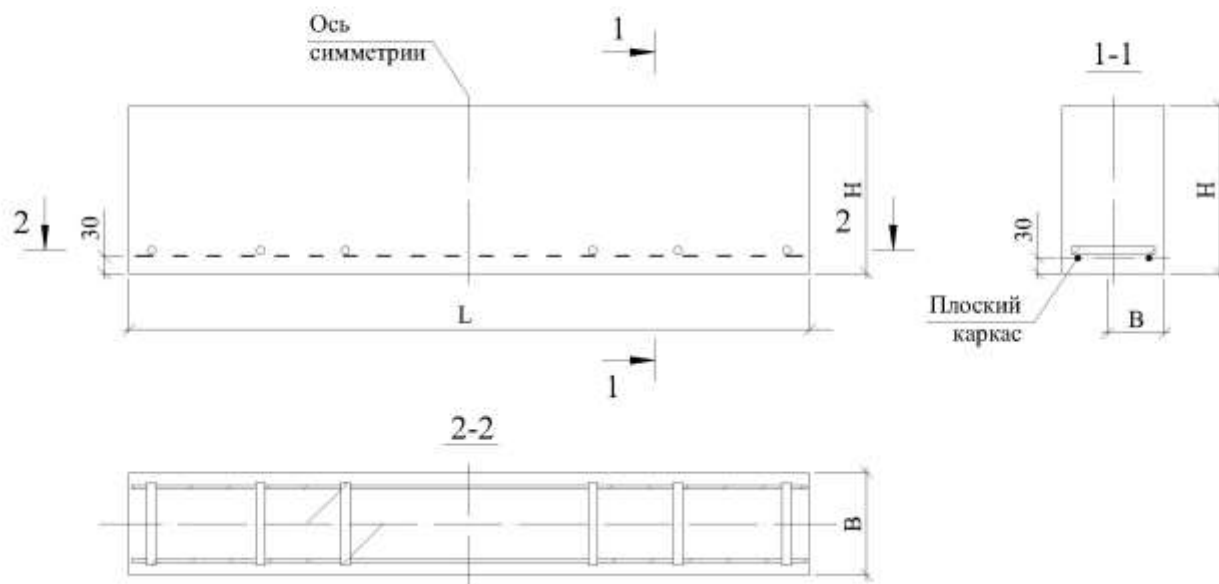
Полистиролбетонная перемычка , армированная плоским стальным каркасом
